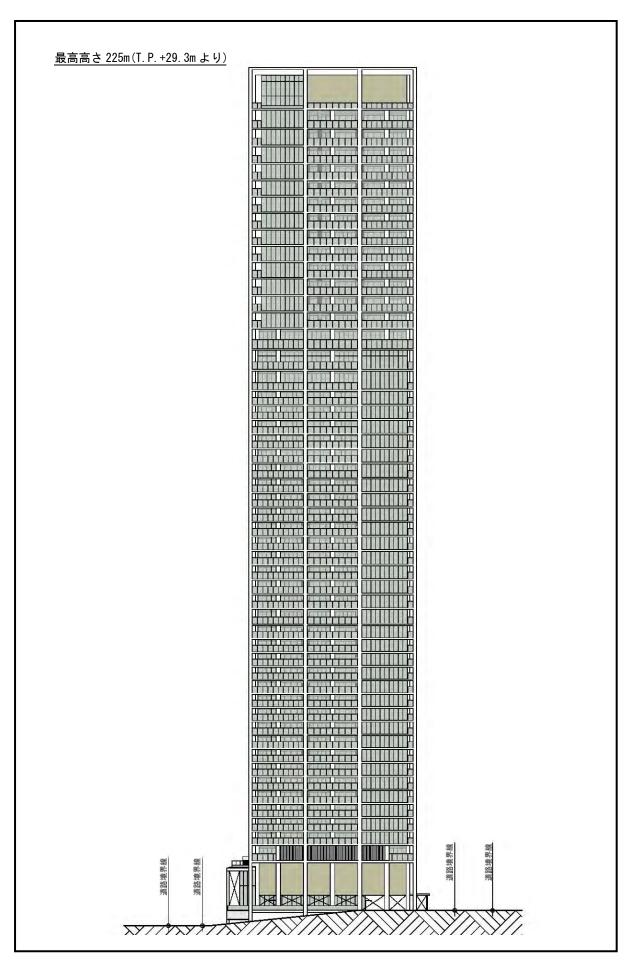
(2) 立面図 (北立面図 S=1:1,000)【変更後】
